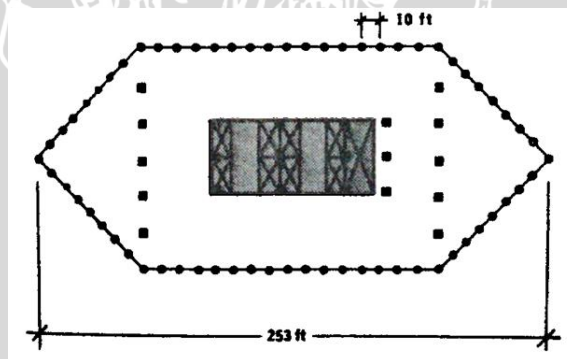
One Shell Plaza Building*, Houston.
